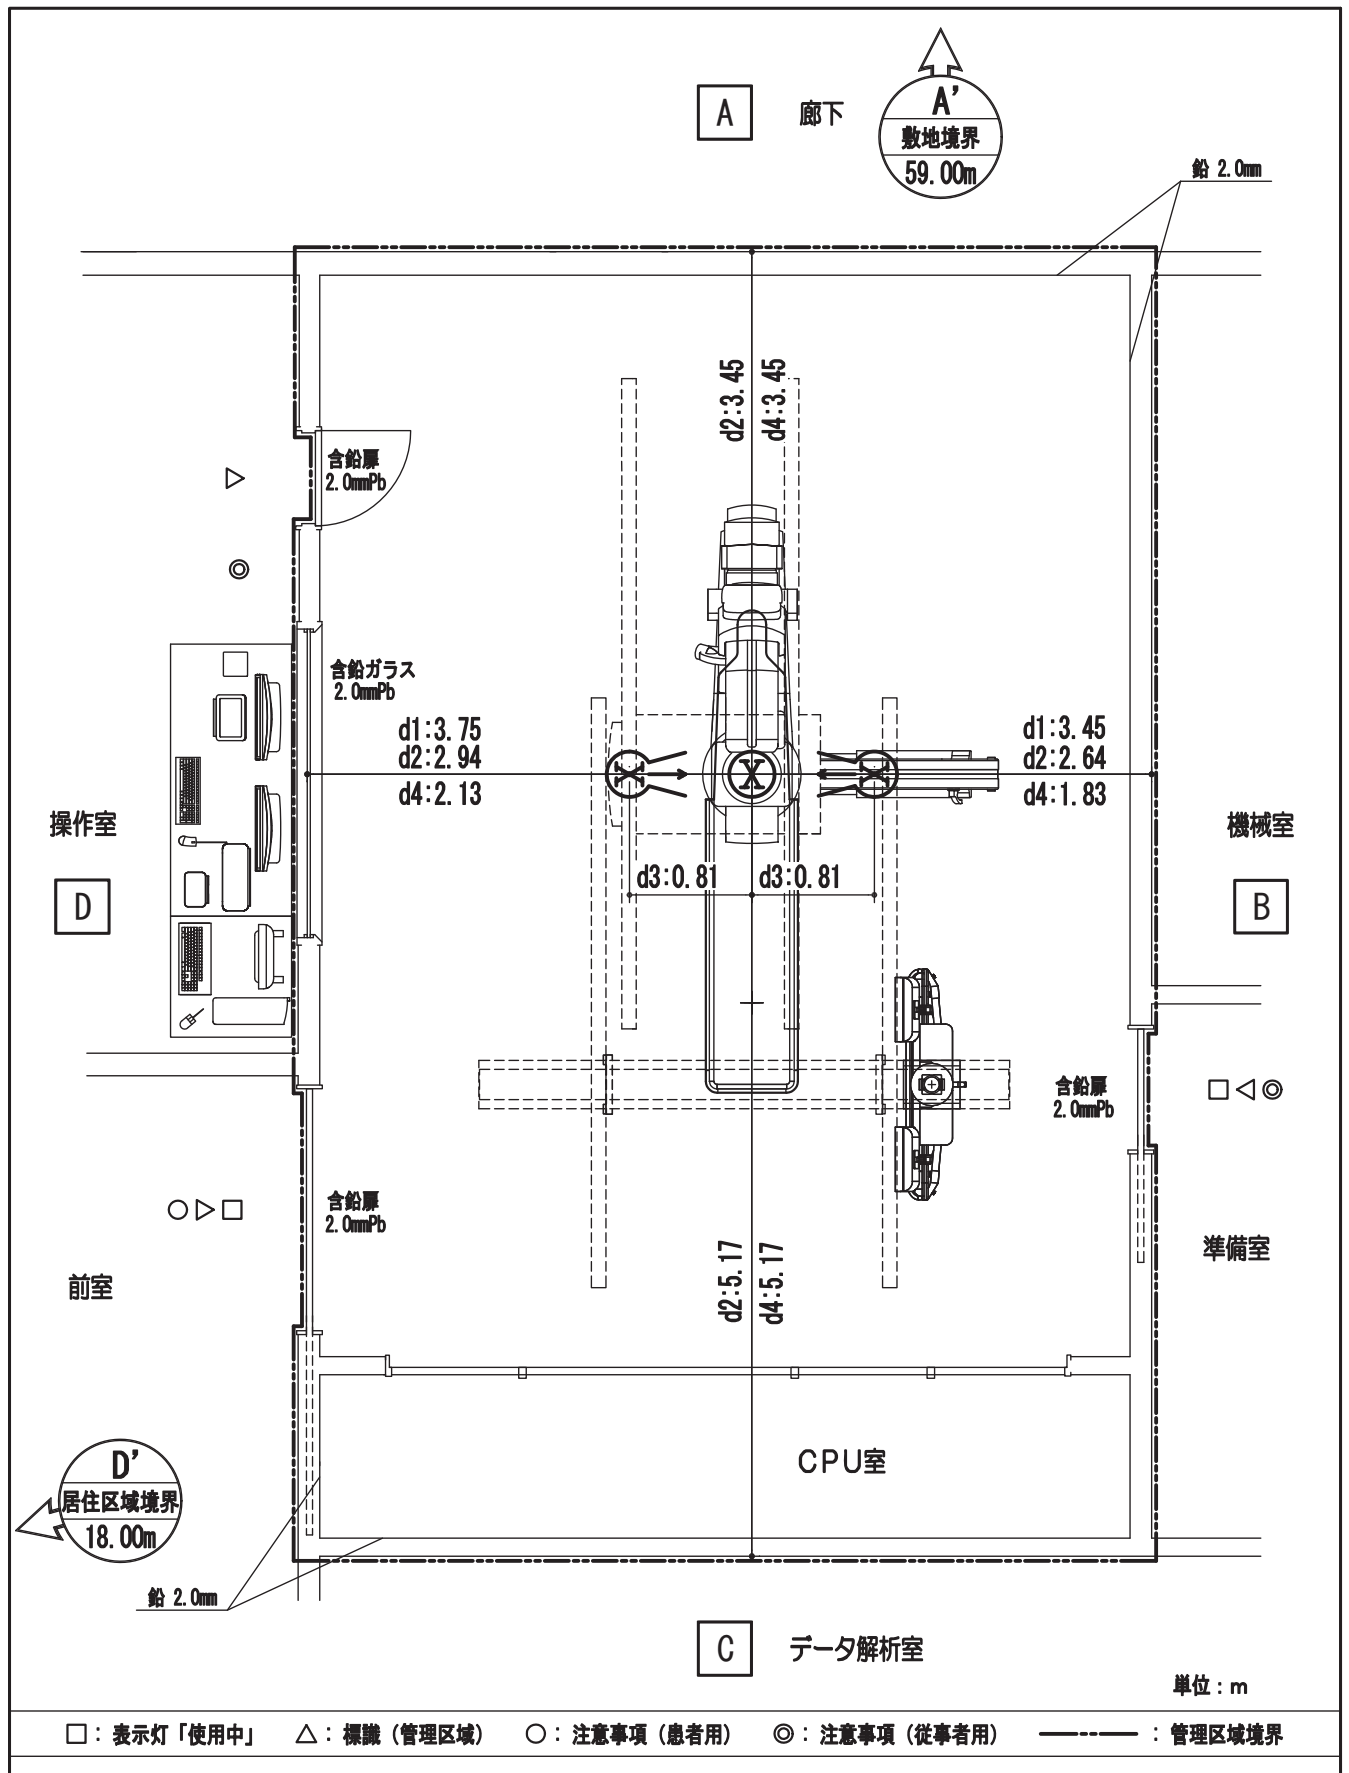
循環器用X線診断装置 床置き管球 透視・撮影 平面図
